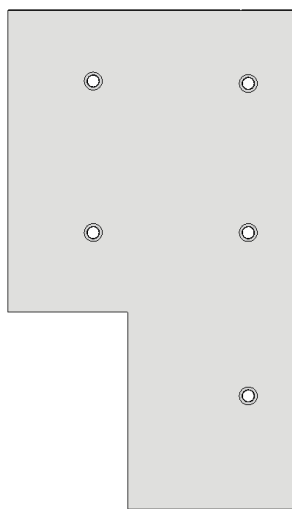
Alternatif 2 Rencana *Ceiling Coffee Lounge
